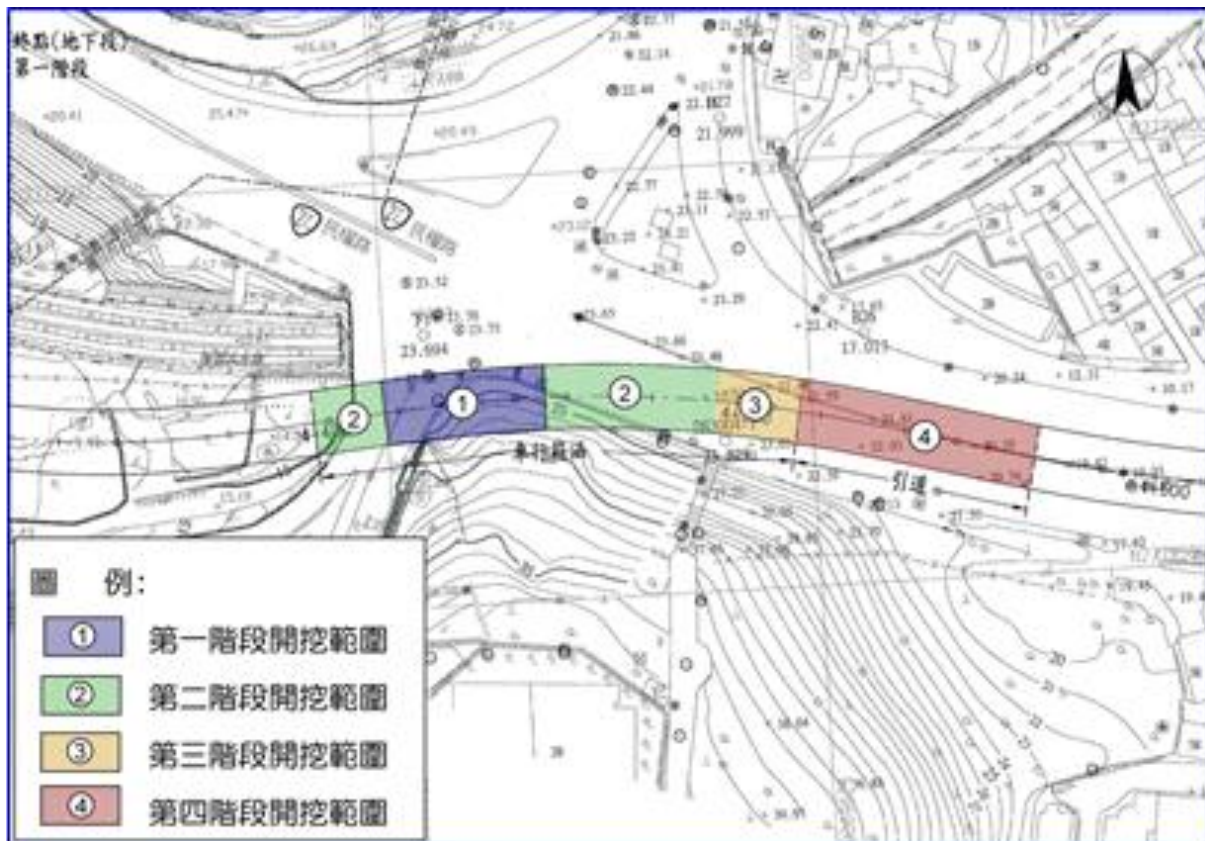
路線南端箱涵分段開挖施工示意圖
